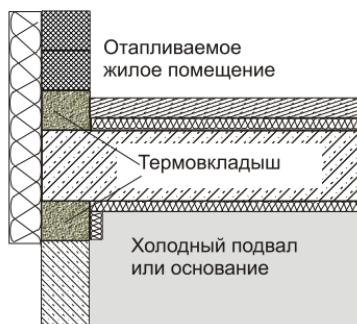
Ликвидация "теплового мостика" в месте стыка наружной стены с подвальным перекрытием и подвальной стеной или с плитой основания и фундаментной стеной за счет установки термовкладыша
